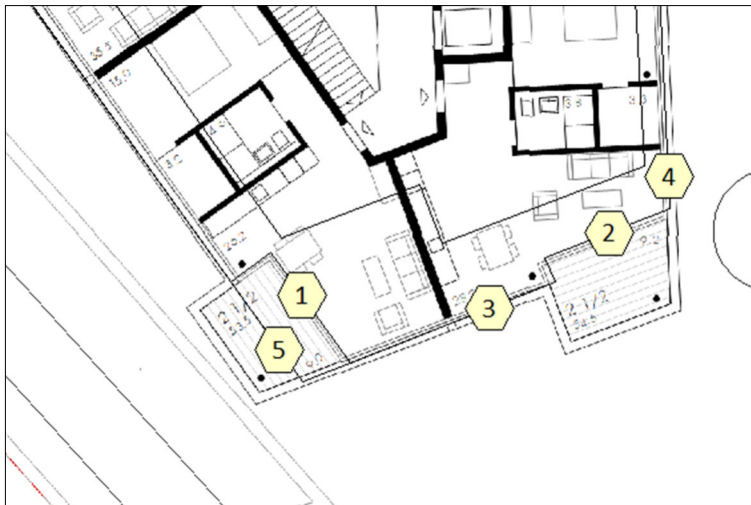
Grundriss Regelgeschoss BF D mit Immissionsorten
